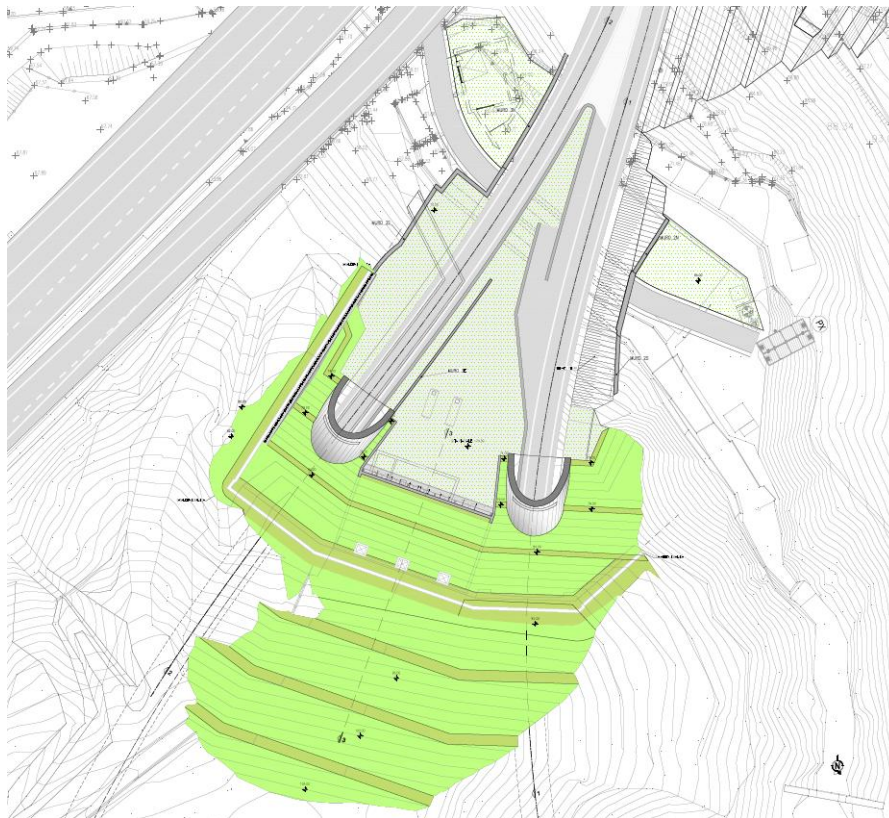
Planimetria delle sistemazioni finali dell'imbocco Polcevera/San Rocco
